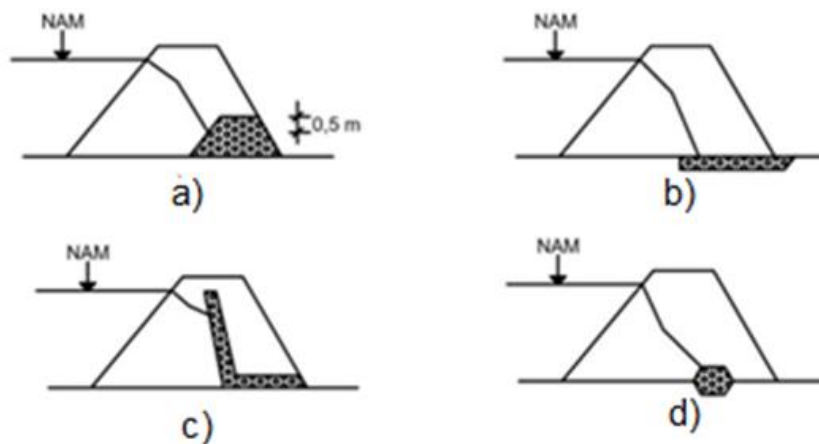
Tipos de drenajes en presas de tierra: (a) Prisma de drenaje, (b) Colchón de drenaje, (c) Drenaje de franja, (d) Drenaje central (Flores Berenguer, 2016)
